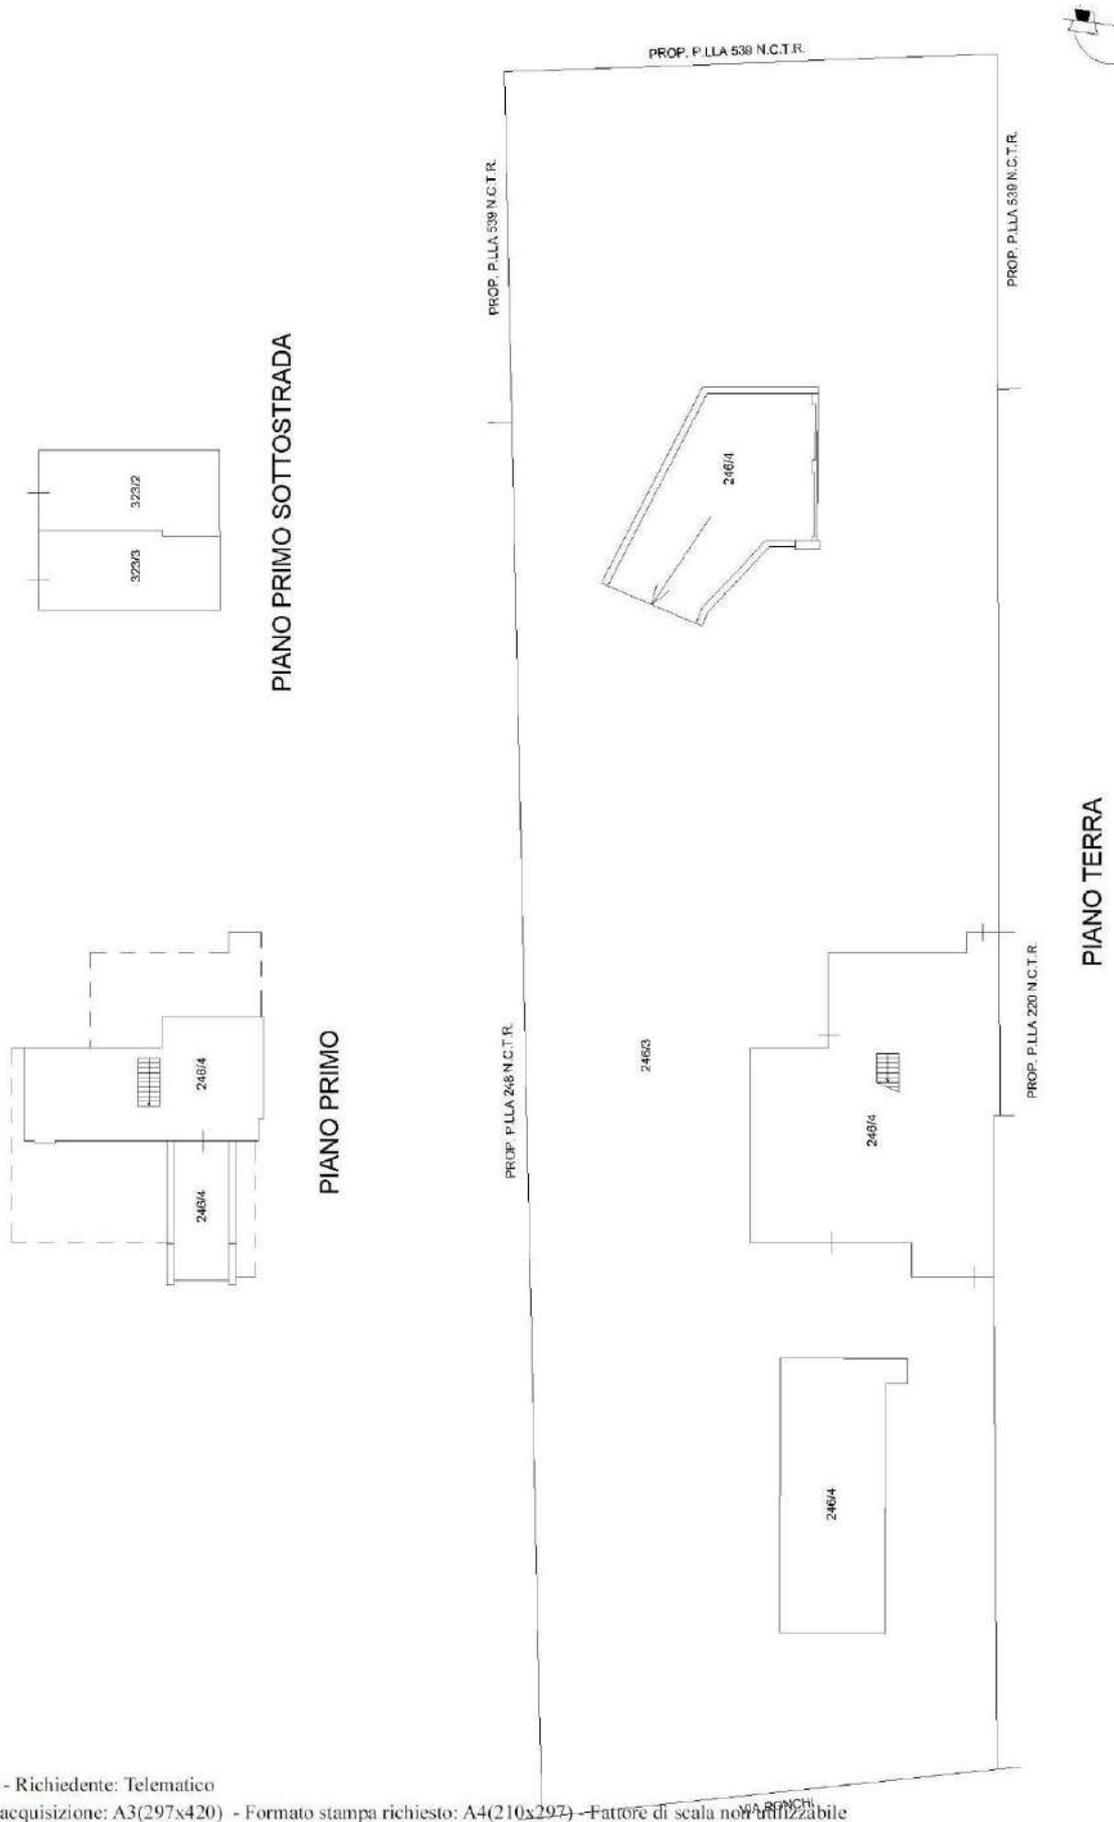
Stralcio elaborato planimetrico dell'immobile
